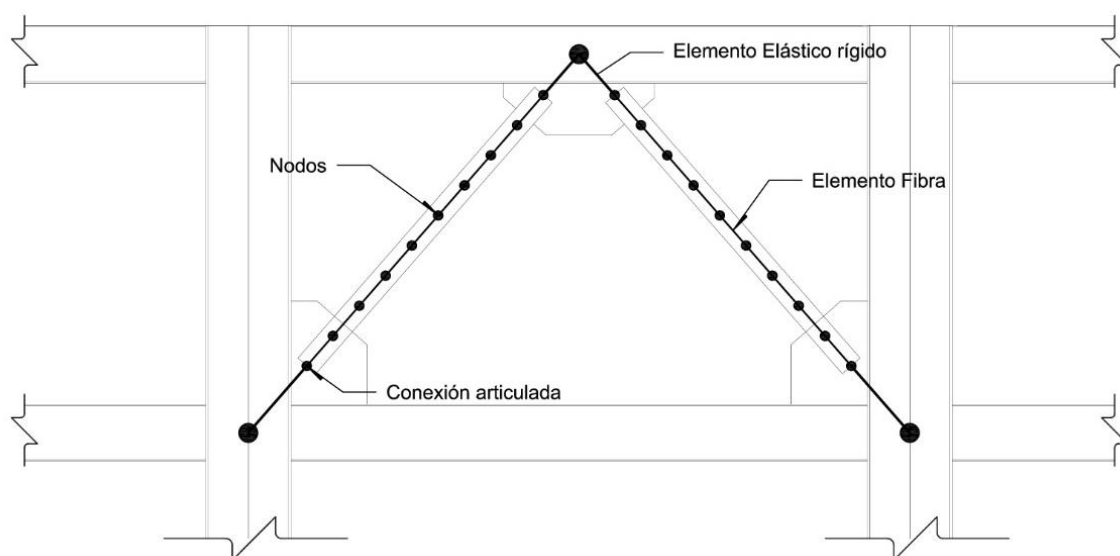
Modelado de los contravientos con elementos fibra en OpenSees
